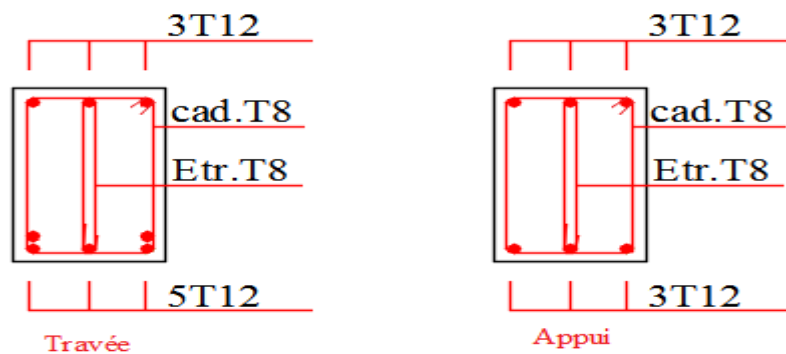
Schéma de ferrailage de la poutre palière de rez de chaussée
